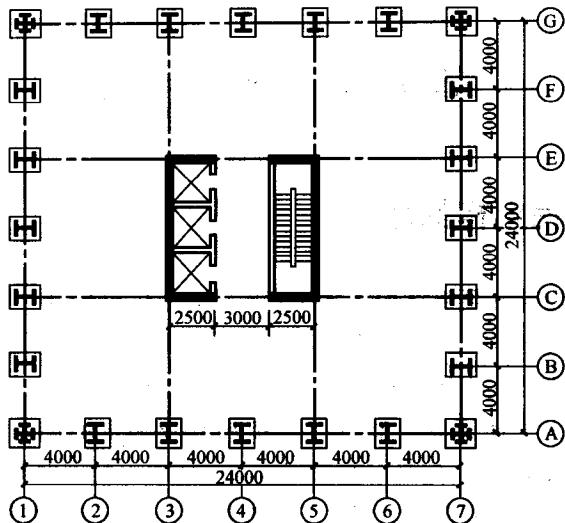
型钢混凝土框架-钢筋混凝土核心筒高层混合结构平面示意图
